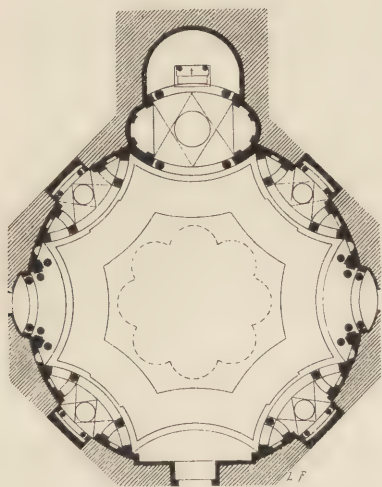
S. Lorenzo zu Turin. Grundriss.
